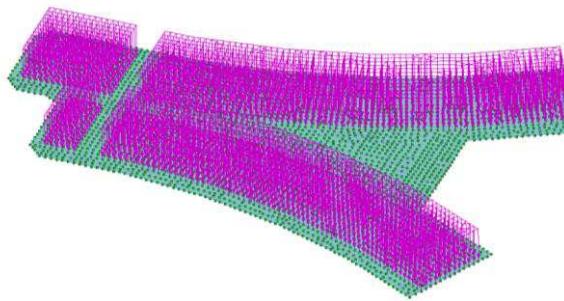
Нагрузка от перегородок, 1-27 этажи
